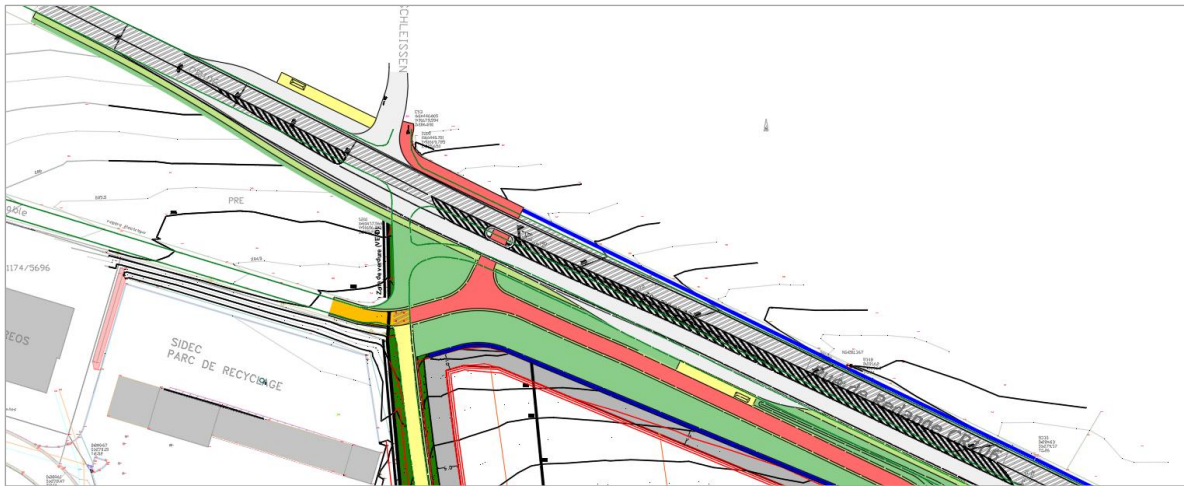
Auszug der Straßenplanung des Büro Berg mit Darstellung der geplanten Bushaltestellen (o.M., genordet)
